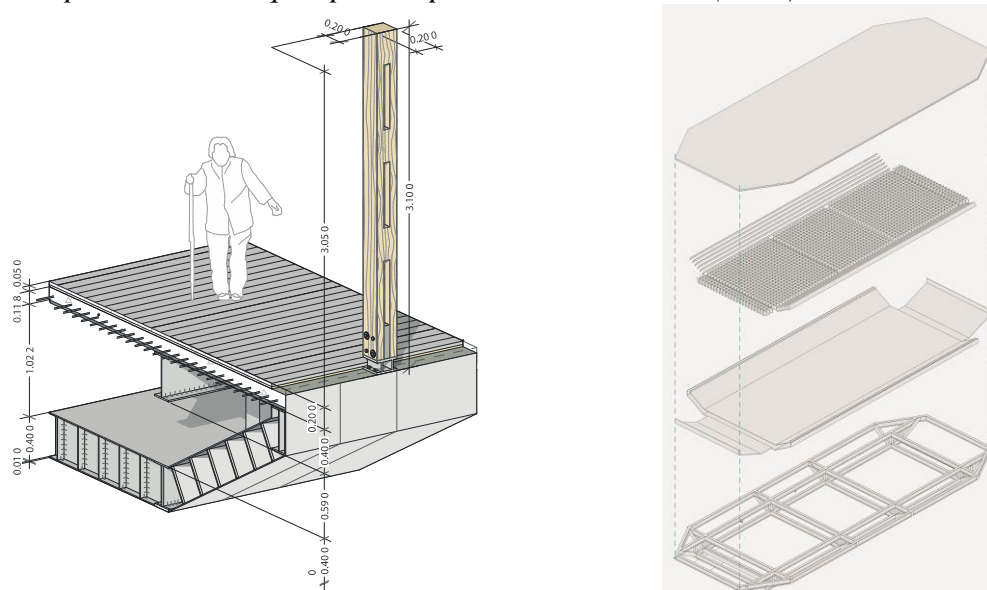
Detalle constructivo de estructura flotante metálica y láminas de acero utilizado en la composición Fuente: Ilustración propia.
